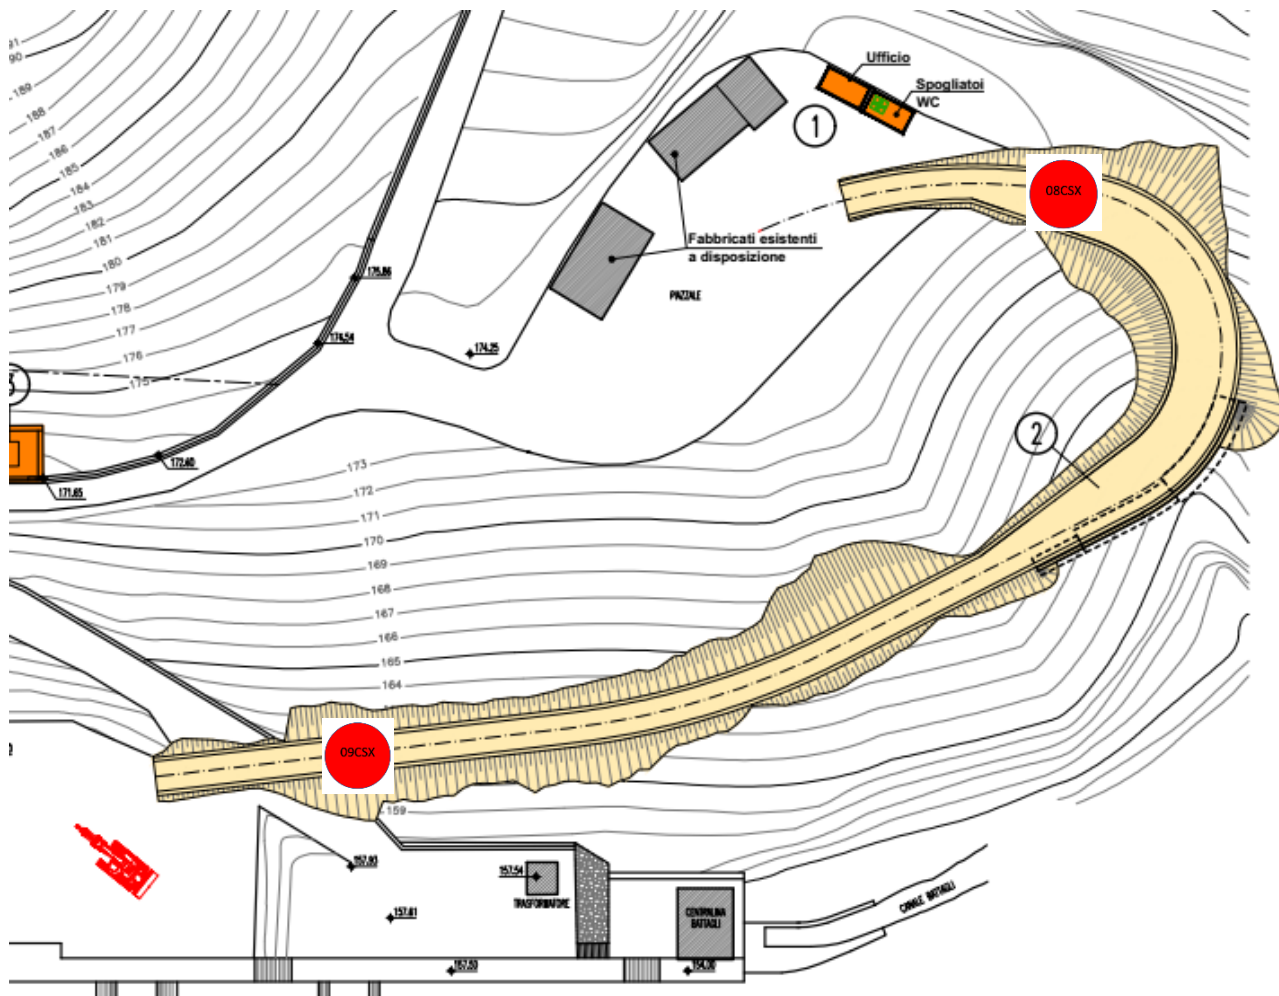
6 – INQUADRAMENTO PLANIMETRICO PUNTI CAMPIONAMENTO SPONDA SX
